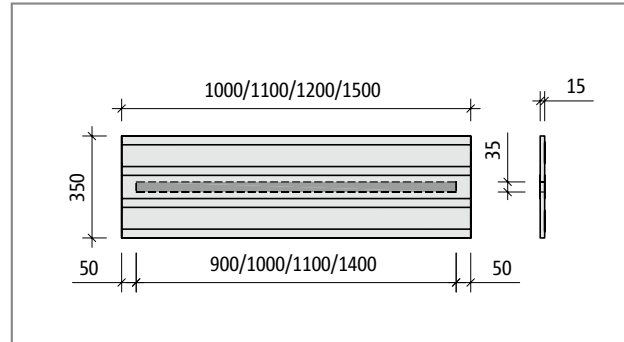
Schöck Tronsole® Typ B-V2-L...-B350: Produktgrundriss
